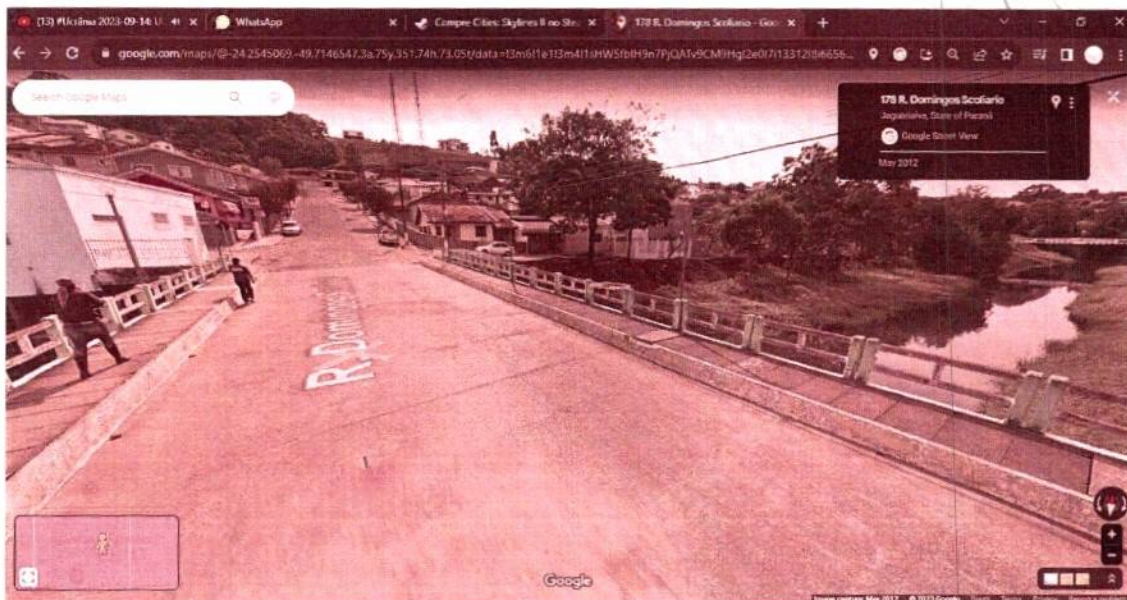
Ponte de Acesso – Centro Belvedere (Vermelho)
